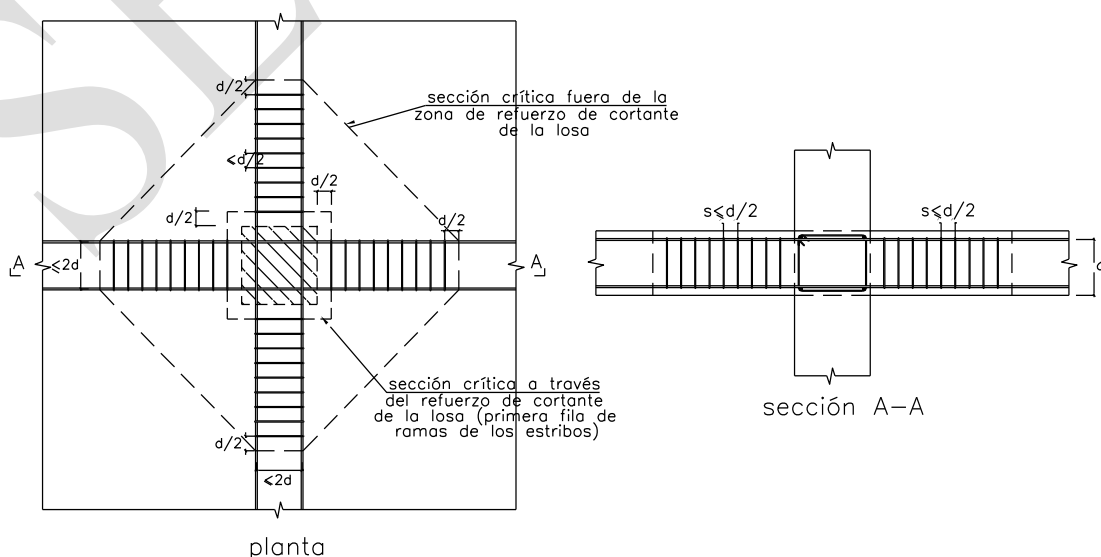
a Disposición de los estribos por cortante en columnas interiores.
